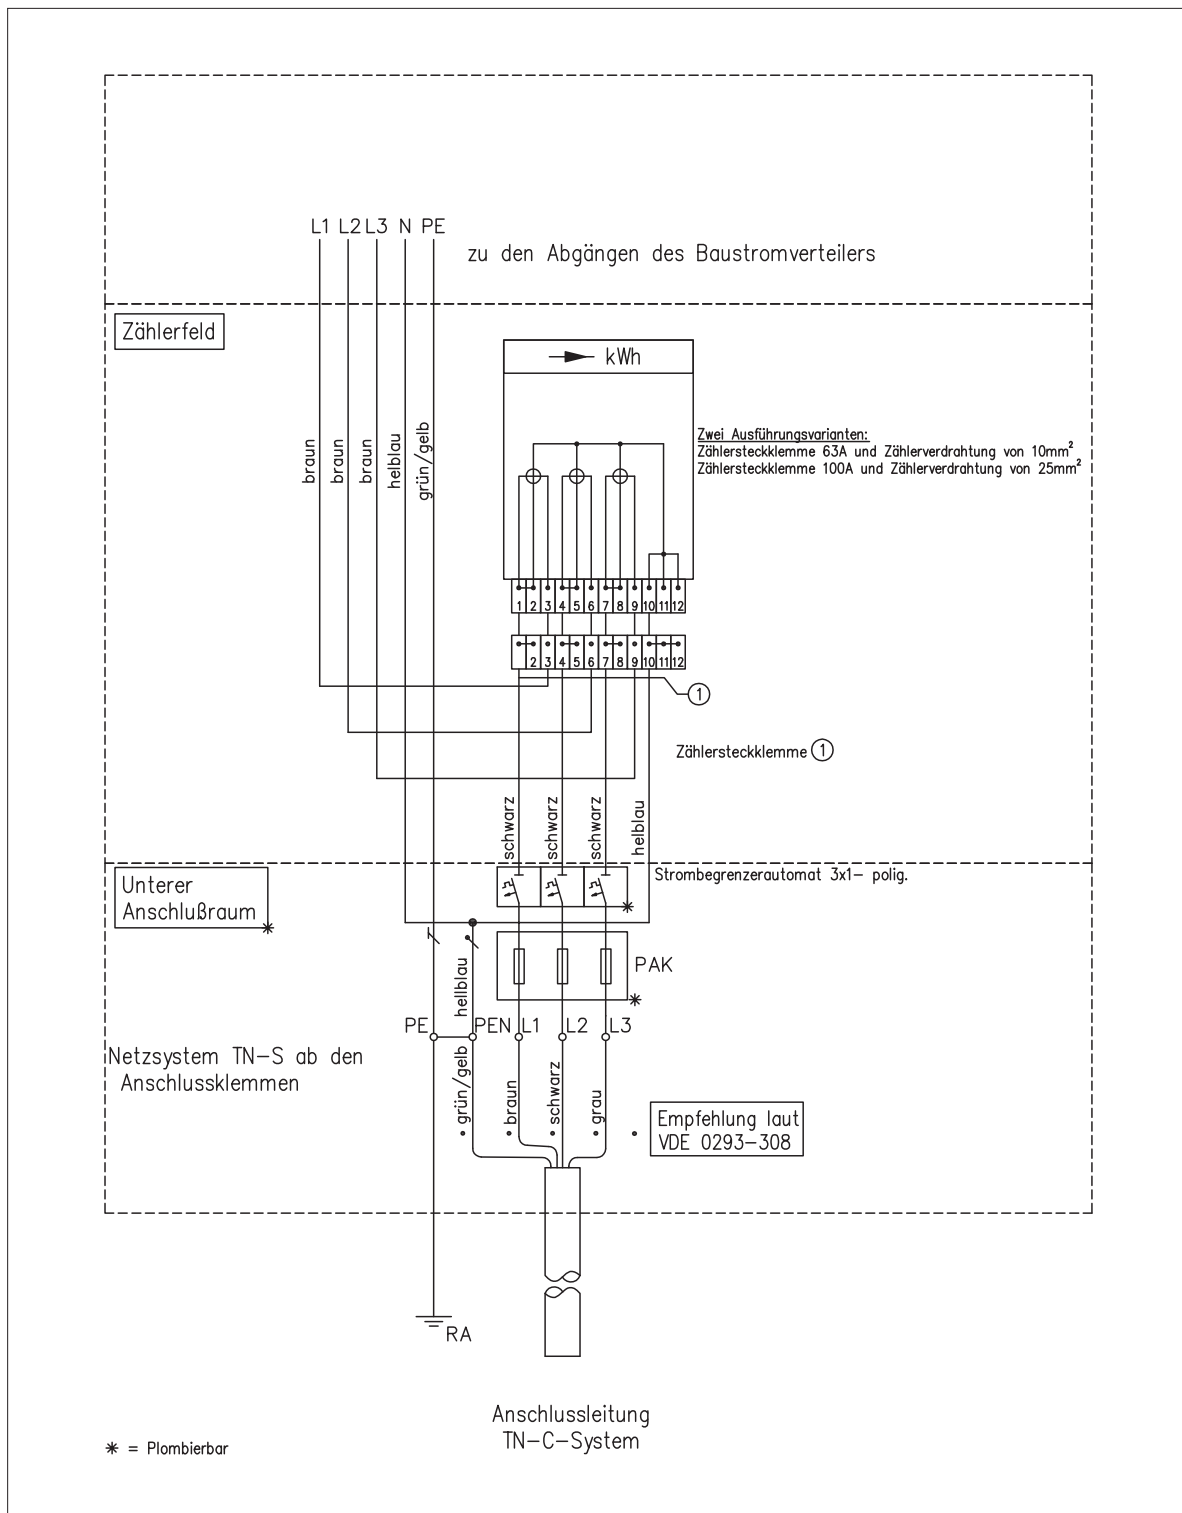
Anschlussschema Baustellenverteiler mit Direktmessung
